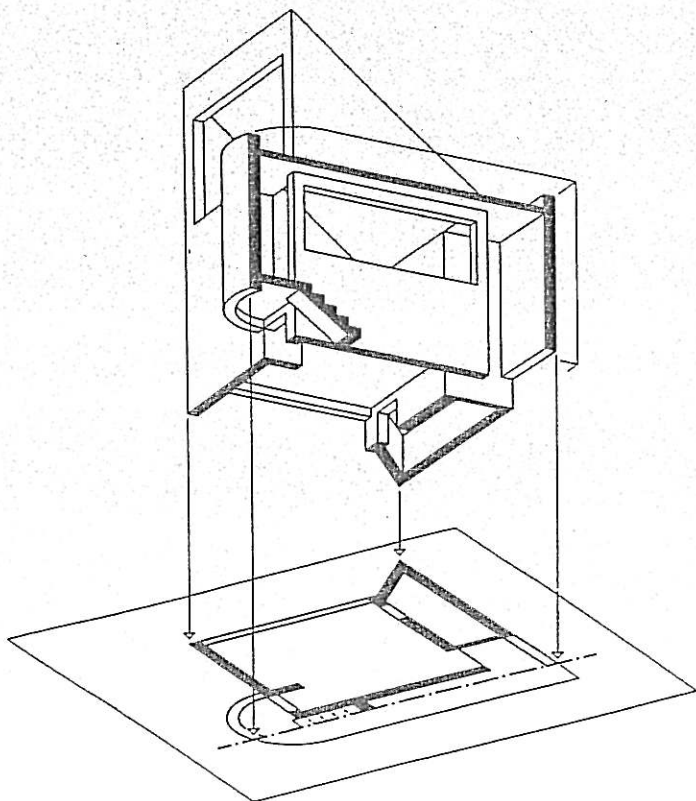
Grundriß Typ B (Abbildungsprinzip)
